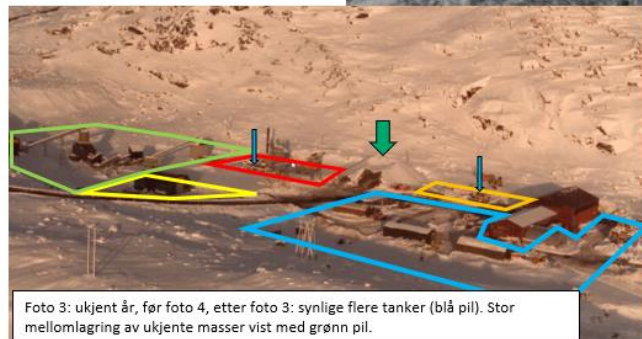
ukjent år, før foto 4, etter foto 3: synlige flere tanker (blå pil). Stor mellomlagring av ukjente masser vist med grønn pil.
